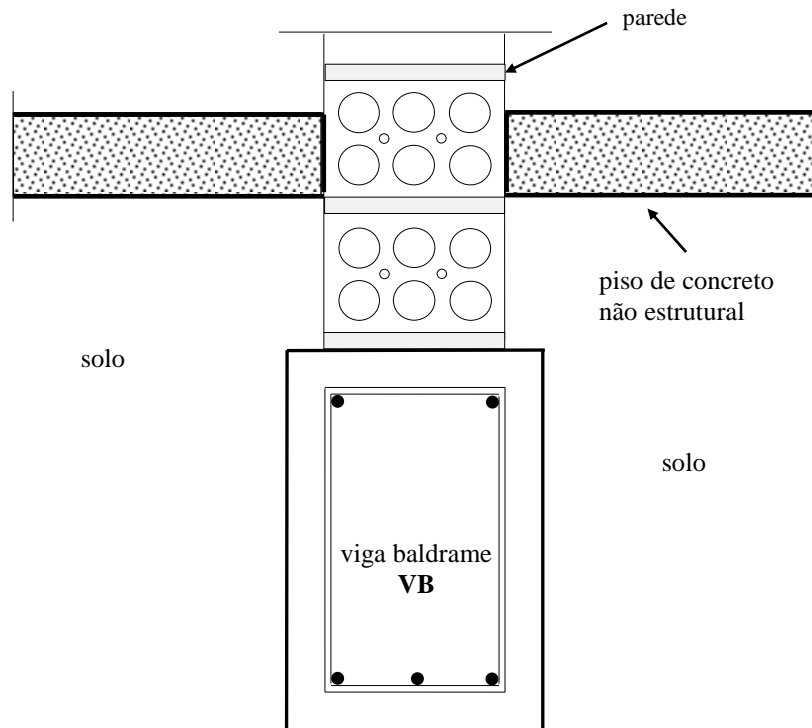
Parede de vedação sobre viga baldrame (VB).
